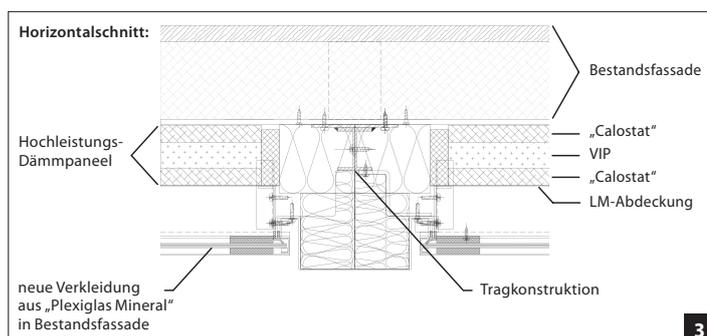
Aufbau des Fassaden-Elements „CT Paneel Multi San“
